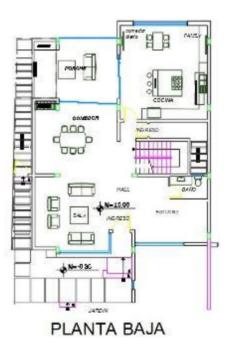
Casa 9- planta baja Elaborado por: Carolina Calupiña M
